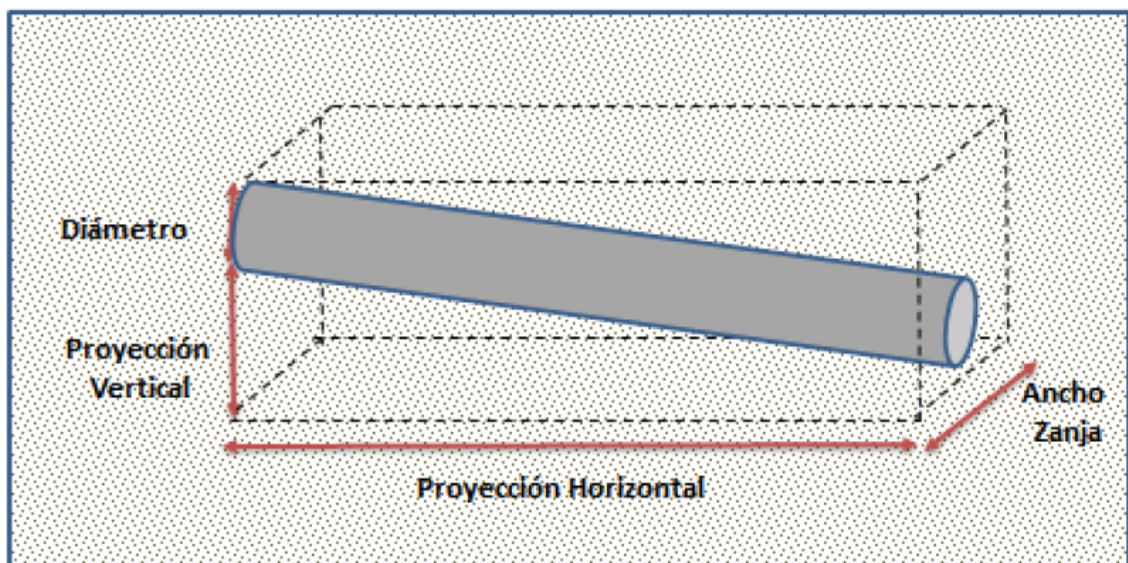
Volumen de Tierra Asociado a la Excavación de la Tubería
